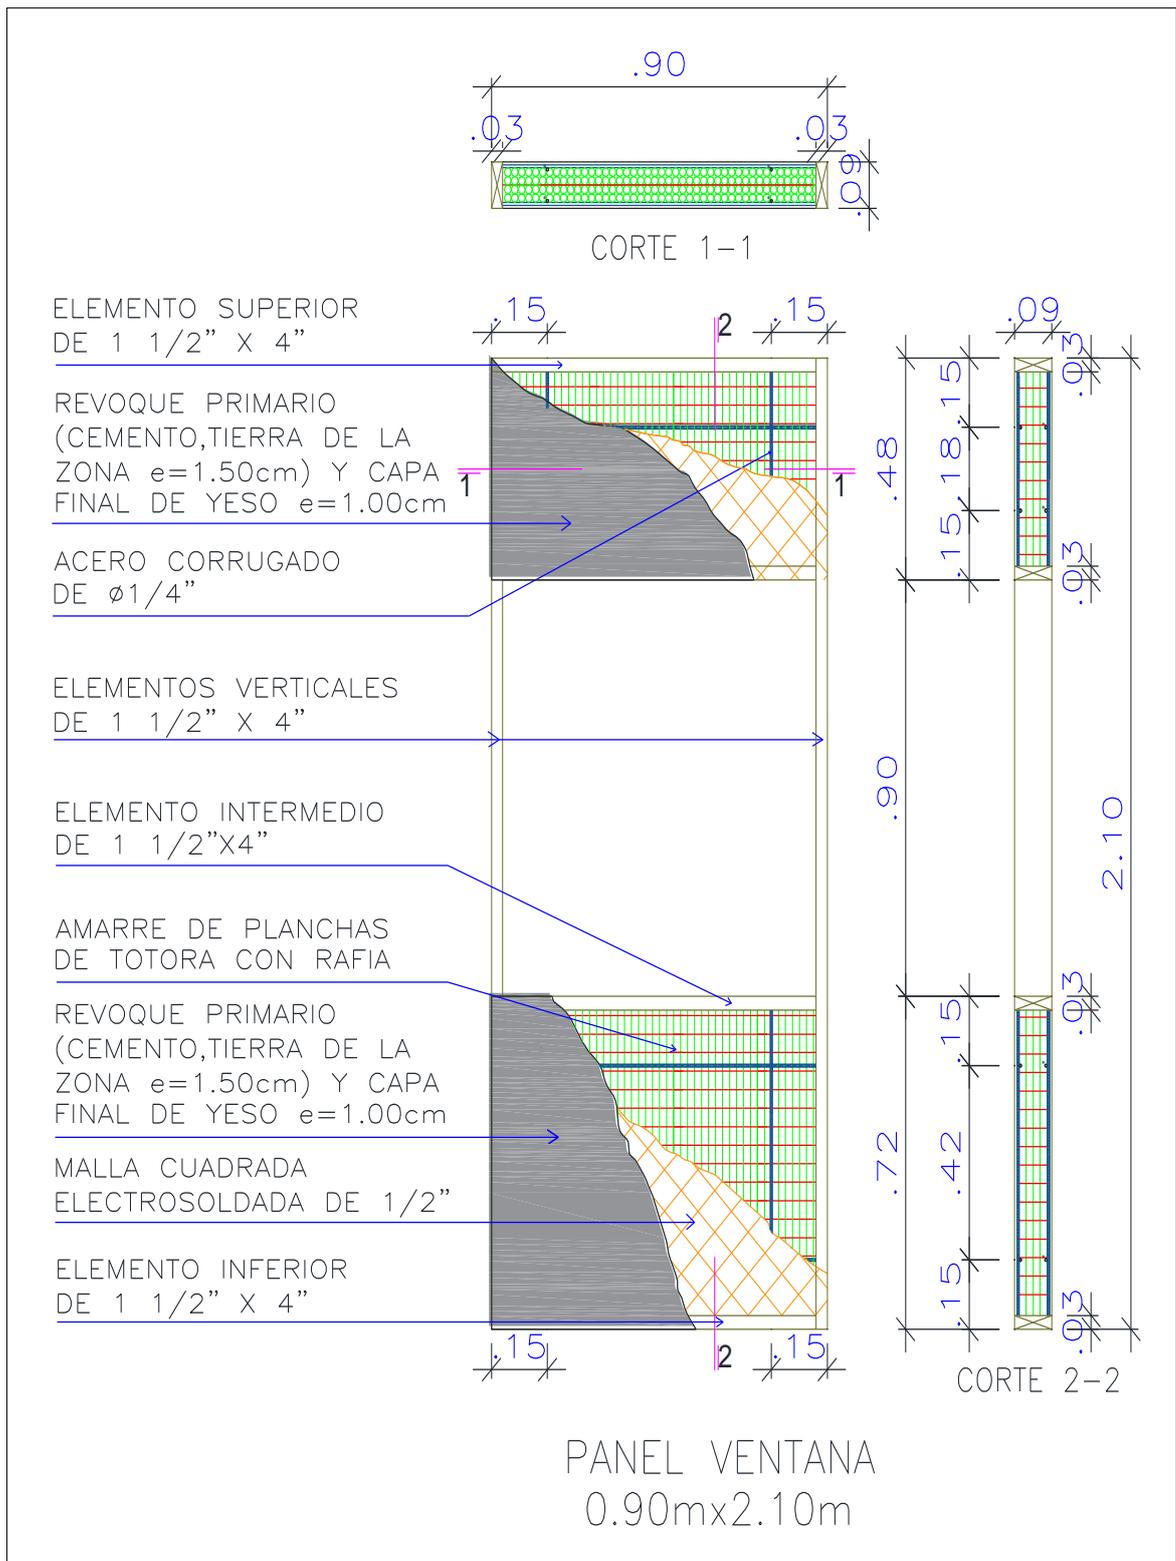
Panel ventana 0.90 m x 2.10 m del sistema constructivo propuesto
